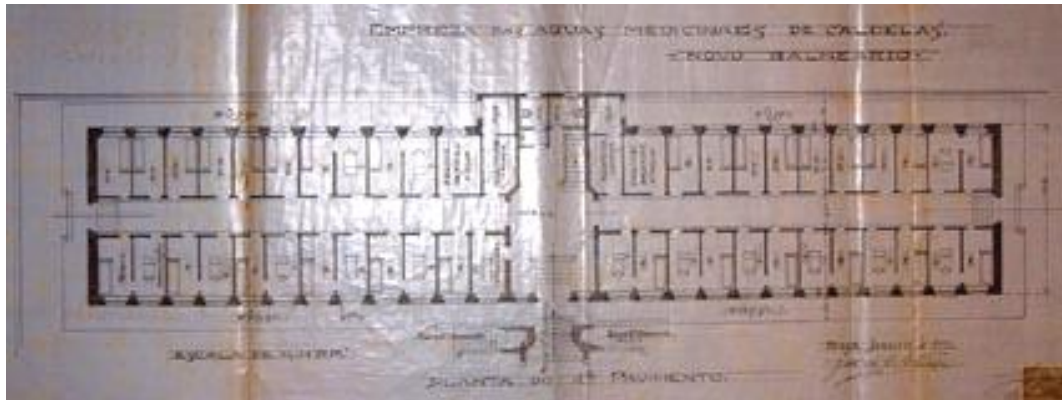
Fotografia da planta do piso Térreo do Balneário (1922).
